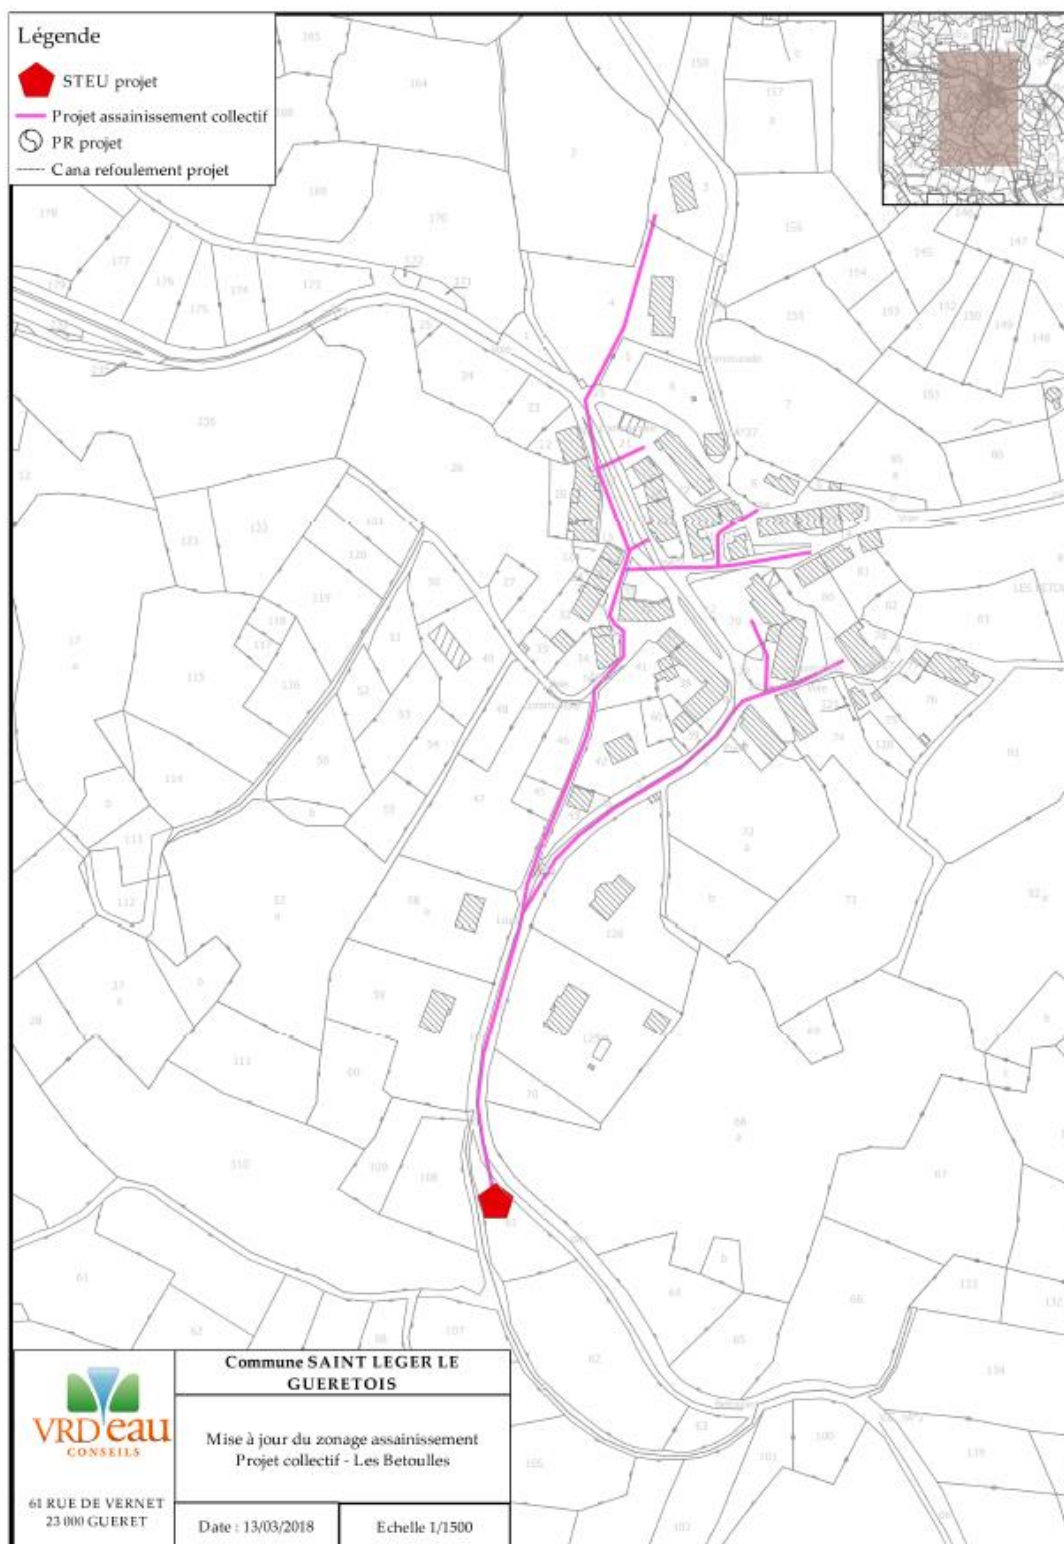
projet d'assainissement collectif sur le village des Betouilles
